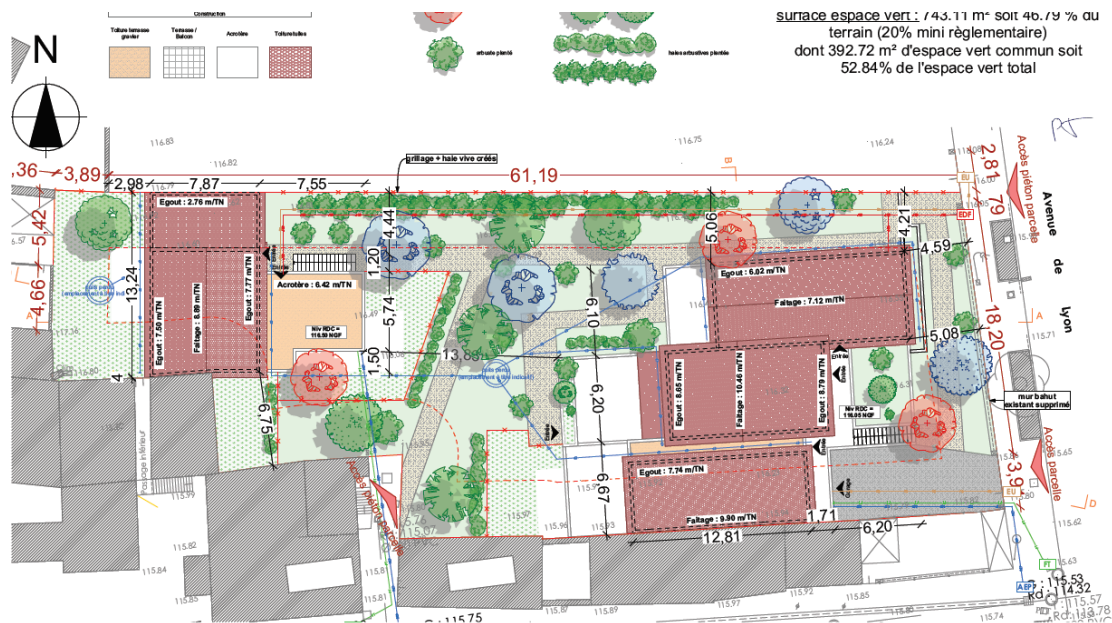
plan de masse des bâtiments 2 et 3 [6]
